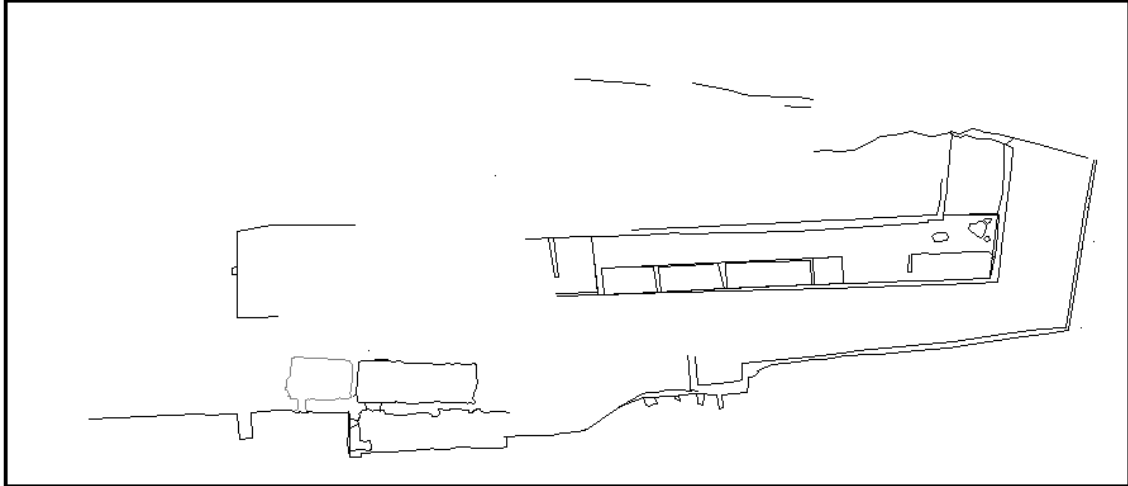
Planta del Monasterio con la información del campamento 2010 y en las salidas a campo.
